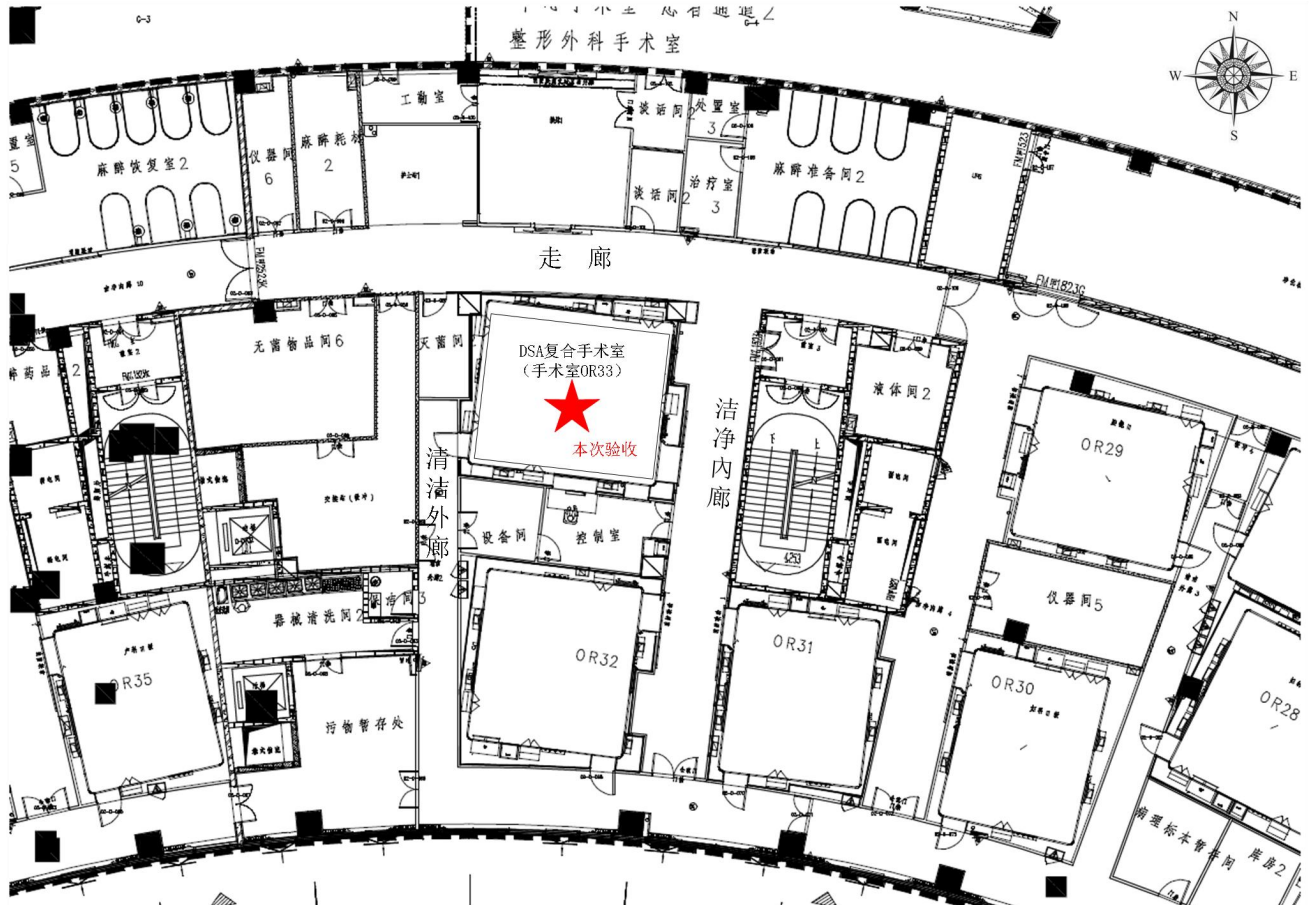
西安国际医学中心医院北院区康复医学中心楼二层裙房D区平面布置示意图
